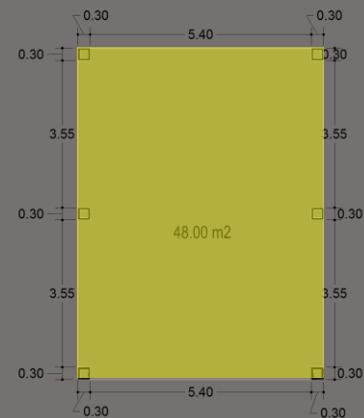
Aula taller de dos plantas para cálculo de zapata aislada.
